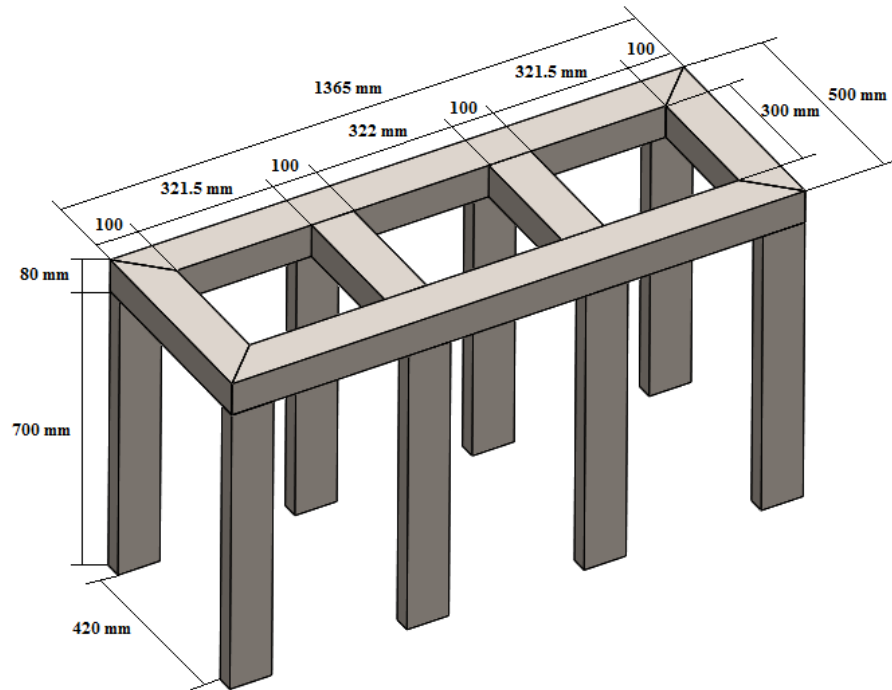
Esquema de la distribución de las columnas y vigas.
